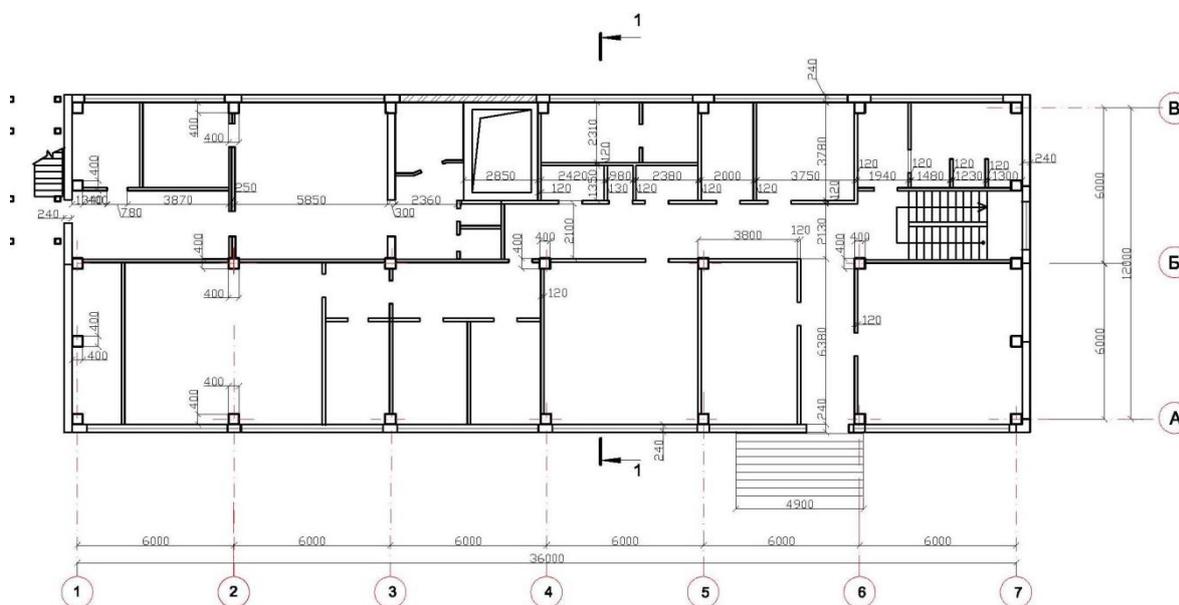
Grundriss Erdgeschoss des Verwaltungsgebäudes (AEROClub)
